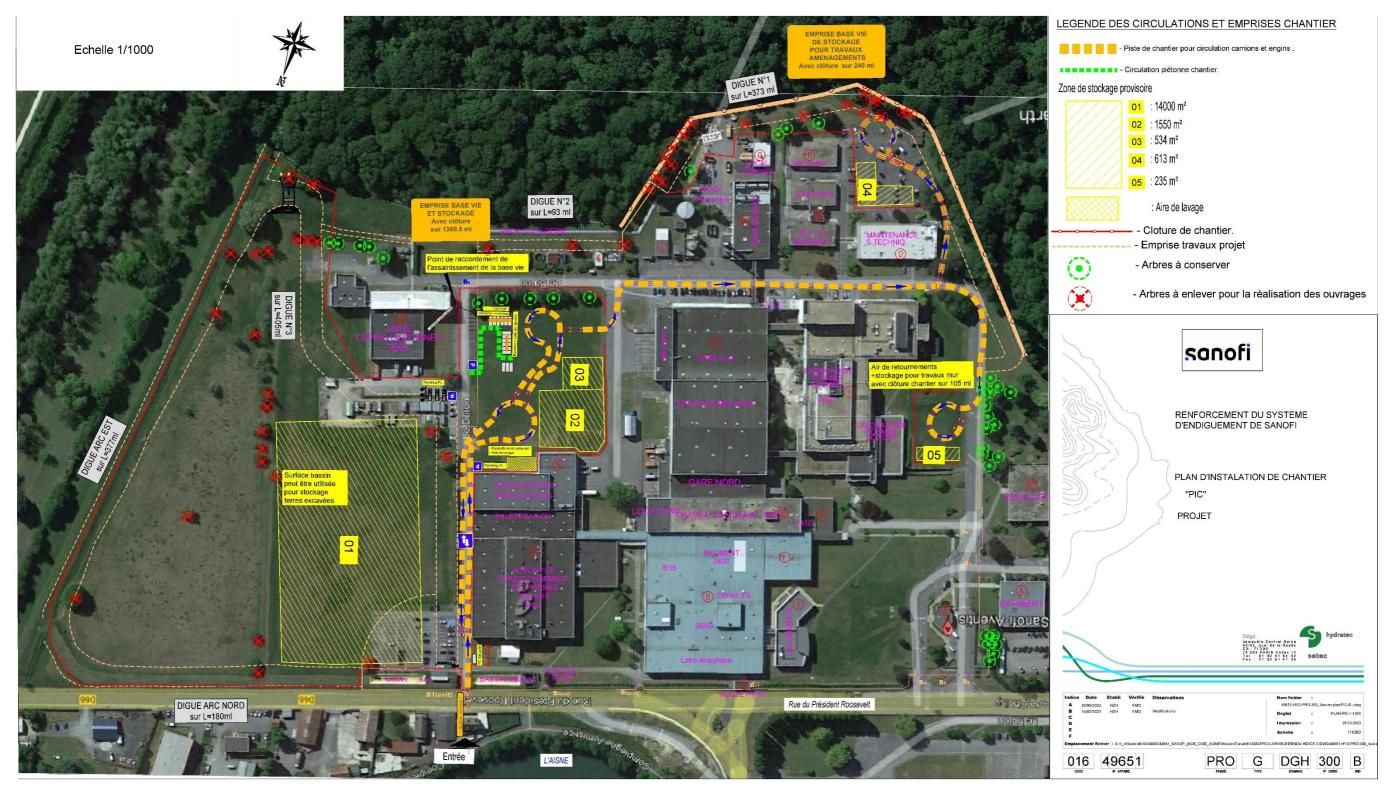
Plan d'installation de chantier et de circulation du projet de renforcement du système d'endiguement de SANOFI
